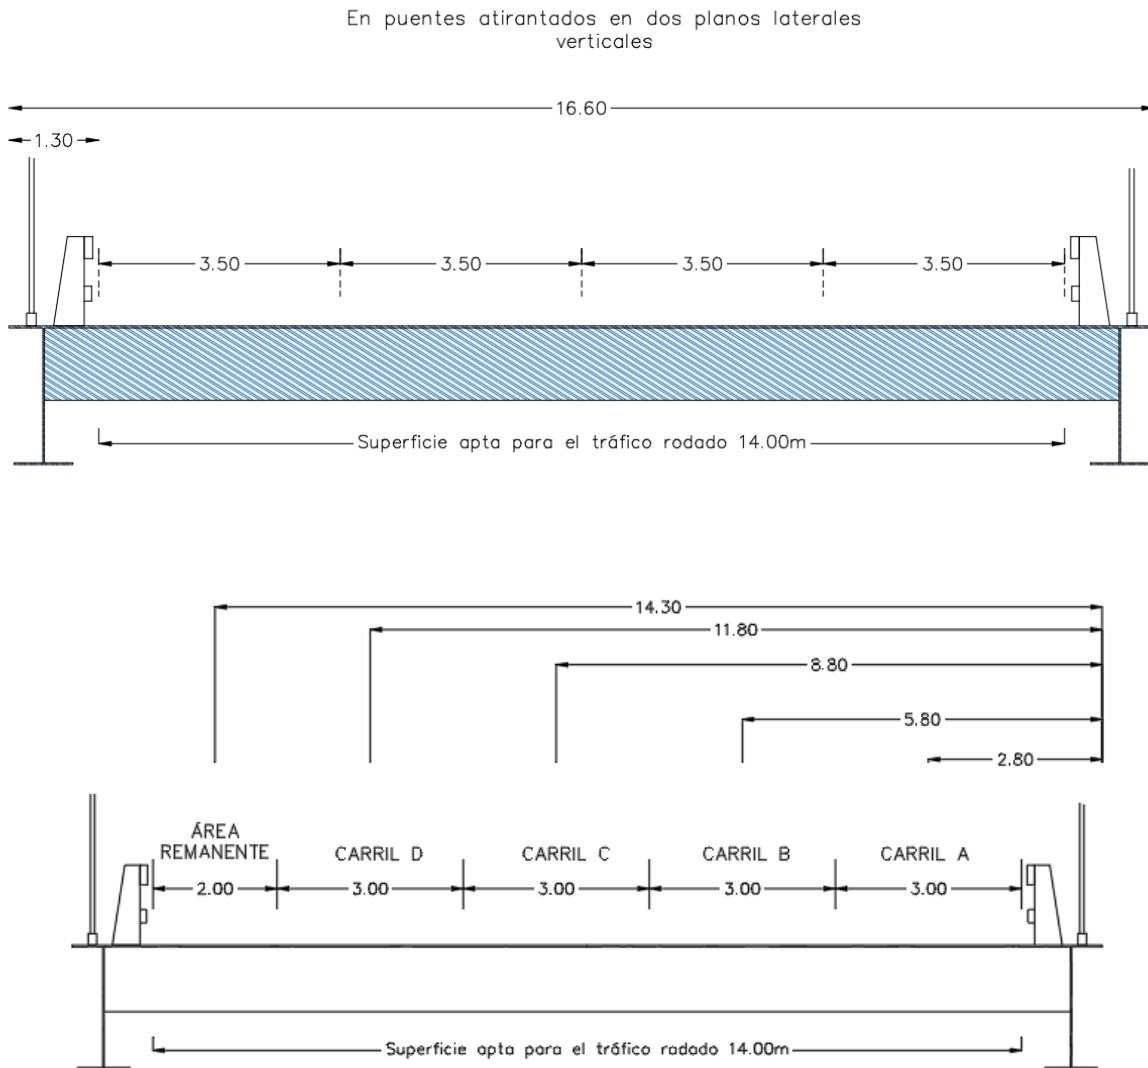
Plataforma y carriles virtuales tablero viga bijnáena
